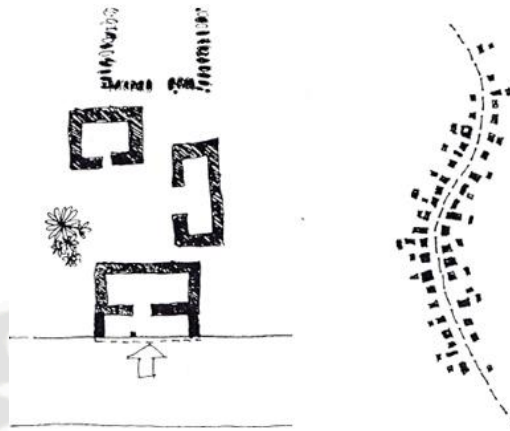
lado izquierdo vista general de los asentamientos, lado derecho vista de detalle de un grupo de asentamiento – fuente: Jorge Burga, vivienda popular en Cajamarca
